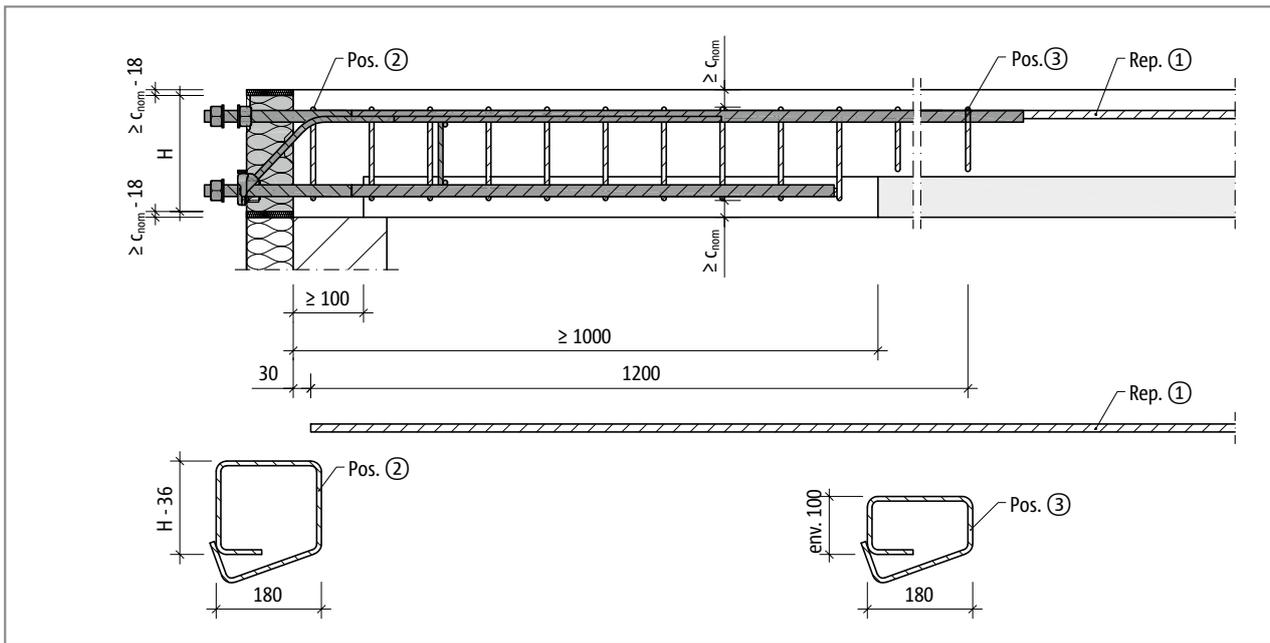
Schöck Isokorb® T type SK-MM2 : renfort sur site avec étriers  $\varnothing 8$  mm pour construction semi-préfabriquée ; coupe
